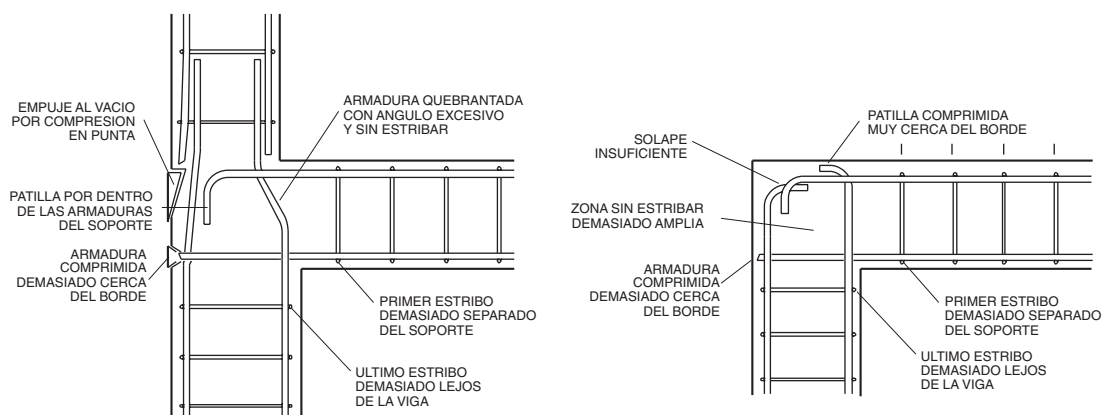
Precauciones en los encuentros de piezas de hormigón
